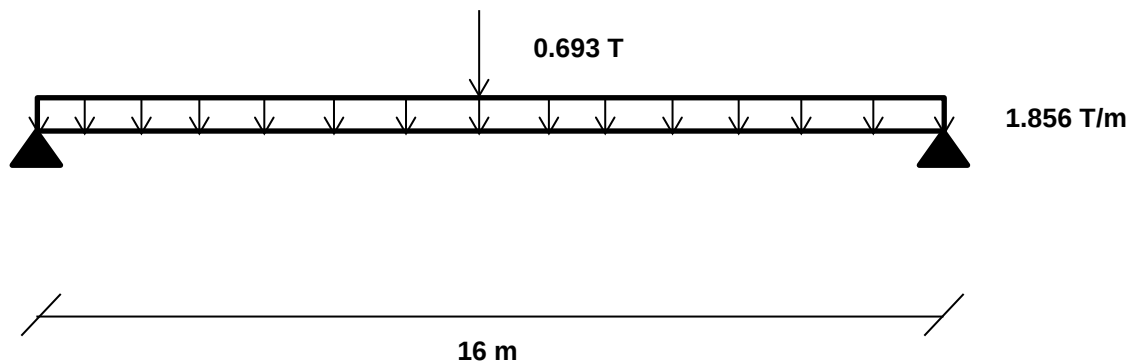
Esquema simplificado de la viga interior longitudinal apoyada sobre los estribos, con la carga muerta que actúa en ella.
